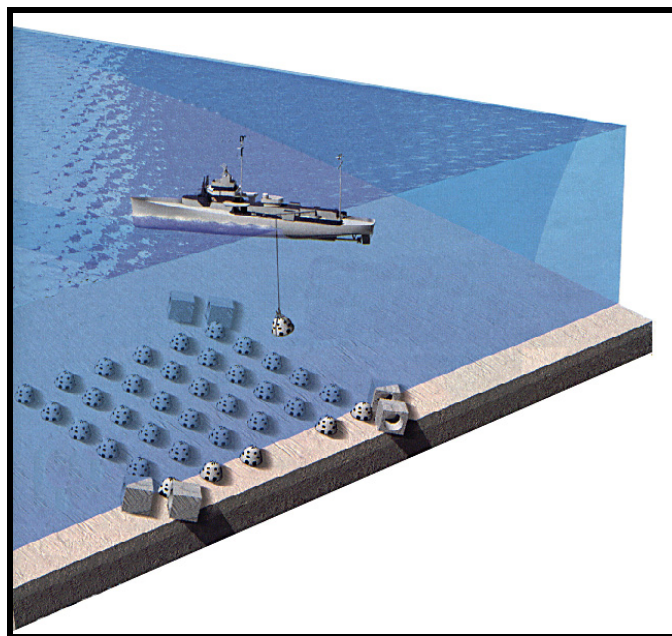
Planta 3D (croqui de instalação dos grupos recifais).
